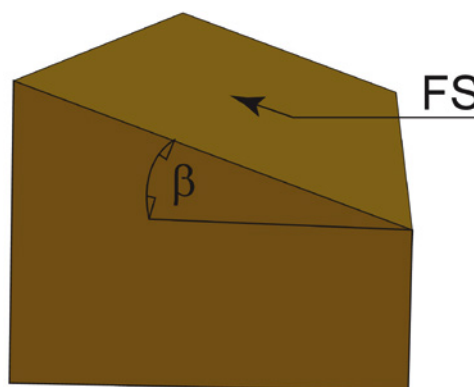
Inclinaison de la face supérieure pour écoulement transversal de l'eau
